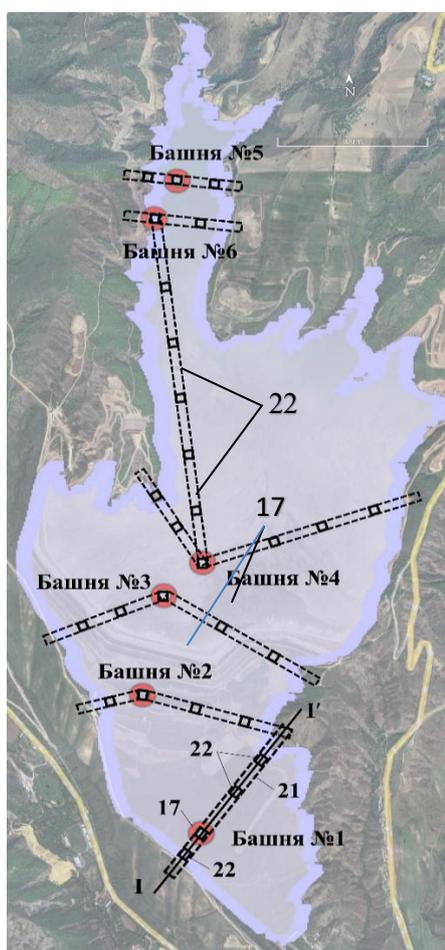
Схема расположения металлических мостовых неподвижных площадок между водоприемными башнями и неподвижными опорами на примере хвостохранилища Арцваник
